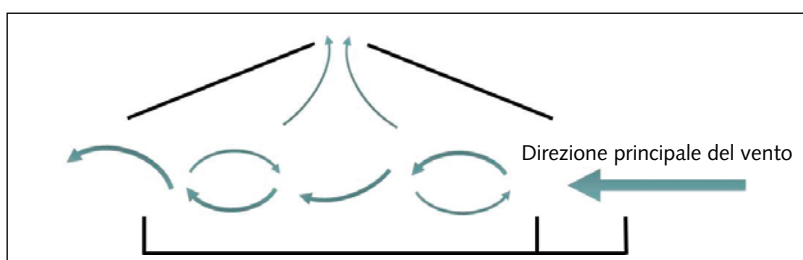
La ventilazione trasversale dipende soprattutto dalla situazione del vento. Per ottenere un buon clima in stalla è necessario che le aperture sul lato lungo della stalla siano sufficientemente dimensionate. L'aria dovrebbe poter entrare senza ostacoli.
